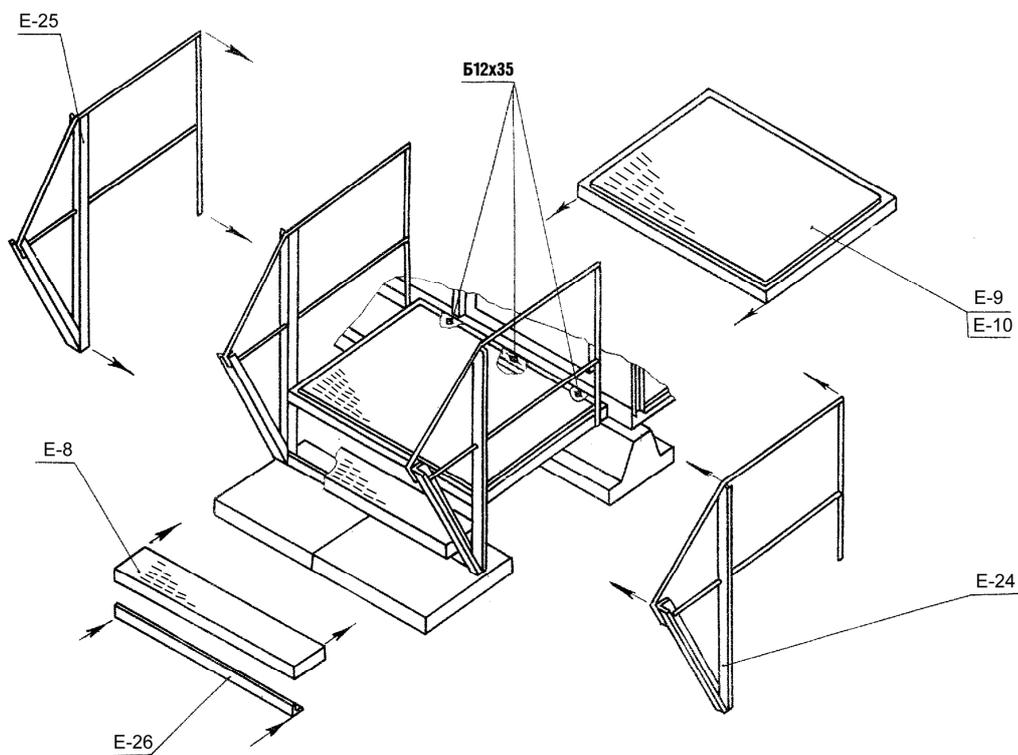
Схема монтажа лестничной площадки (исполнение У1)
